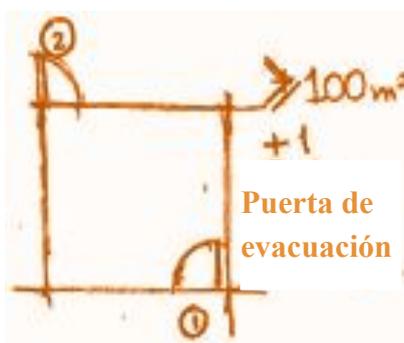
Croquis de número mínimo de puertas por m² de construcción.
